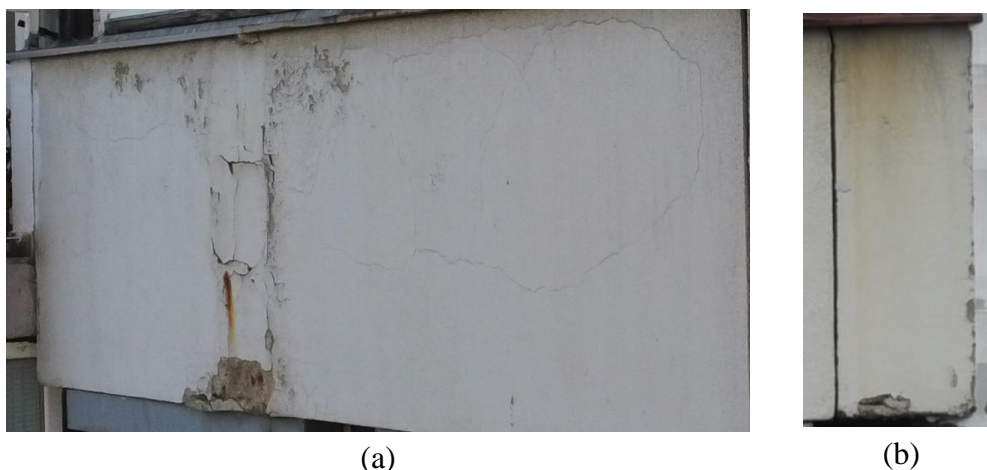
Ljuškanje i odvajanje završnog dekorativnog maltera u gornjim zonama parapetnih elementa dužih fasada (parapet $P_{5-6/A,VIII}$)
